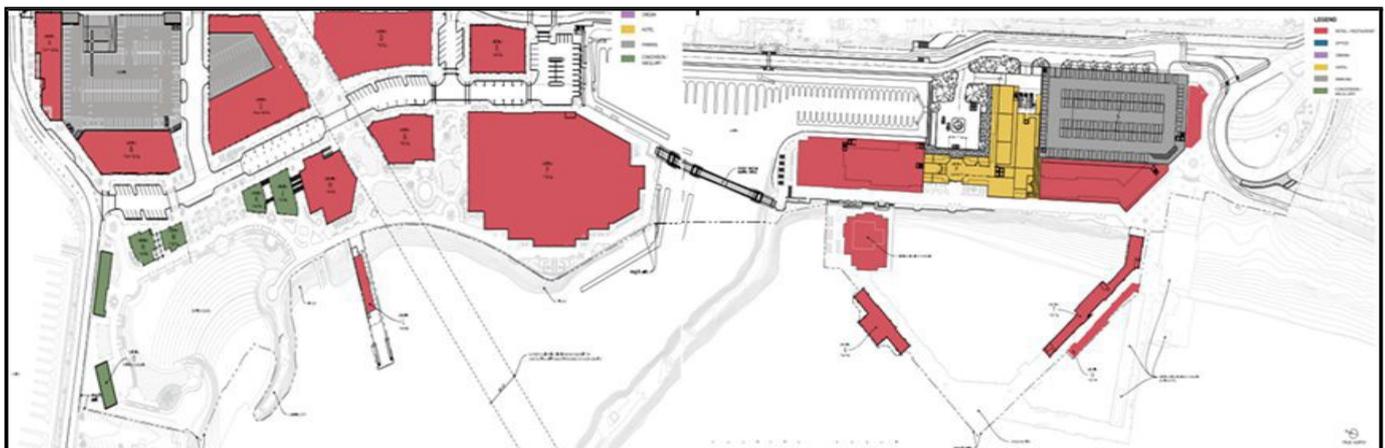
Plan niveau 01. Src: <http://www.thewaterfrontredondo.com/project-overview/>.
